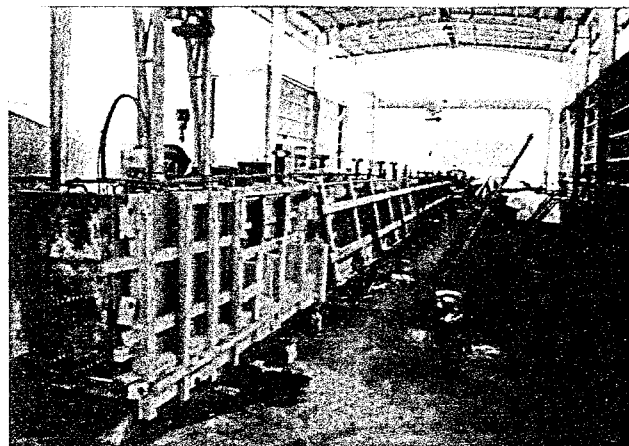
Pembukaan Bekisting Gelagar Beton Pracetak
